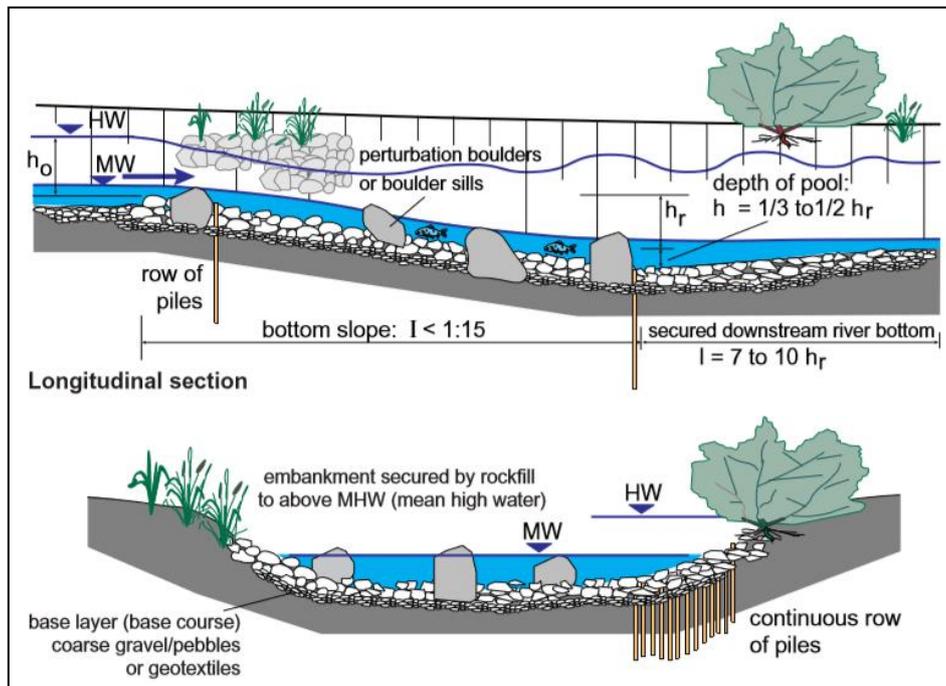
Perfil longitudinal y transversal de una rampa piscícola de piedras.
